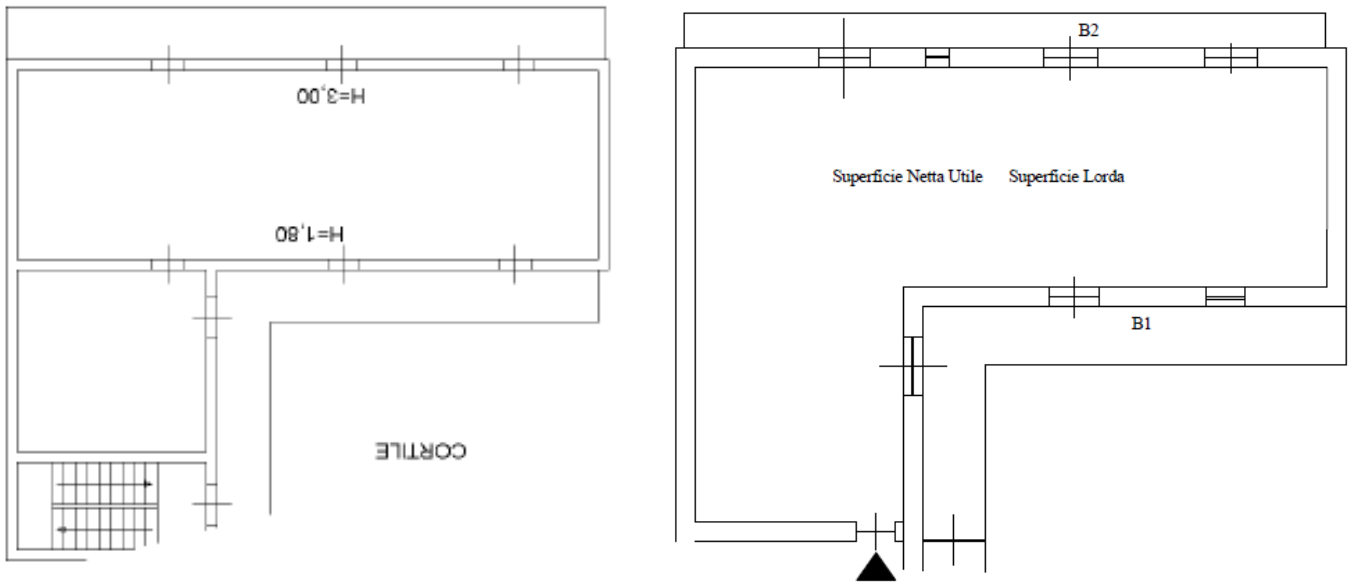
Planimetria catastale dell'immobile al piano secondo e grafico del bene all'attualità.
